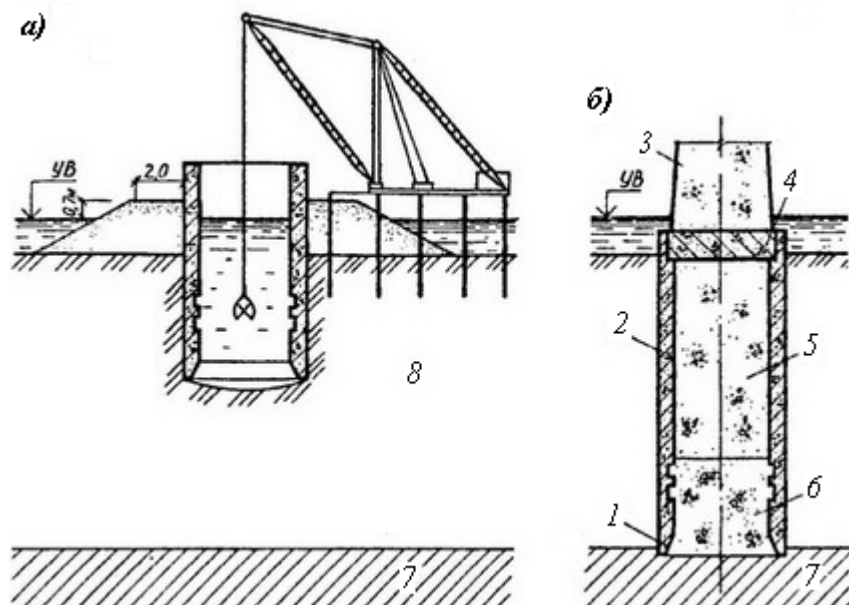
Опускной колодец: а — погружение колодца; б — фундамент в виде опускного колодца; 1 — консоли; 2 — стенки колодца; 3 — надфундаментная часть опоры; 4 — железобетонная плита; 5 — бетон, уложенный насухо; 6 — подводный бетон; 7 — прочный грунт; 8 — слабый грунт.
